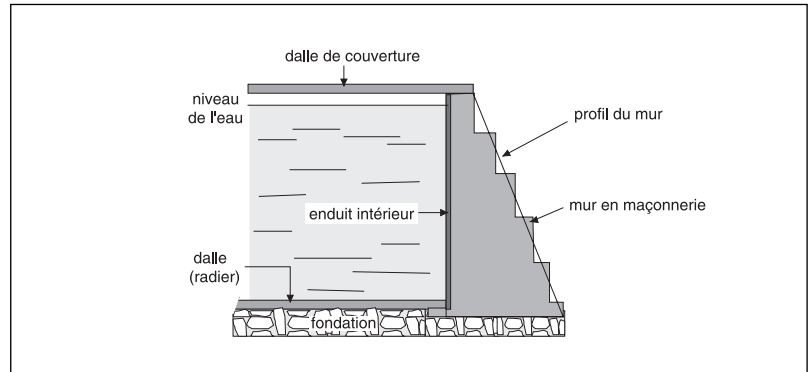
Représentation d'un mur de paroi de réservoir (vue en coupe).
